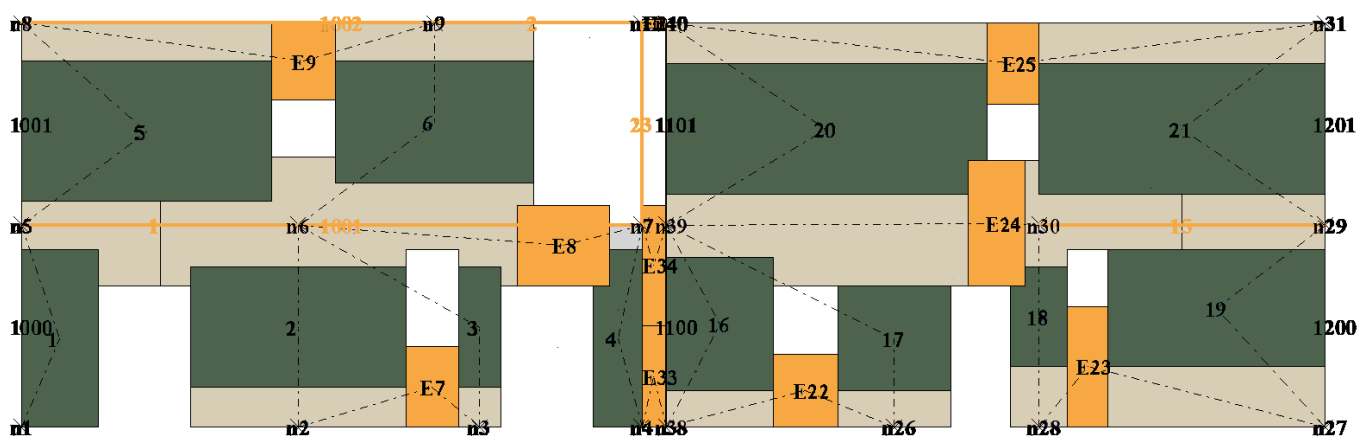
Prospetto Parete 1 - Modello Scollegato singola parete
